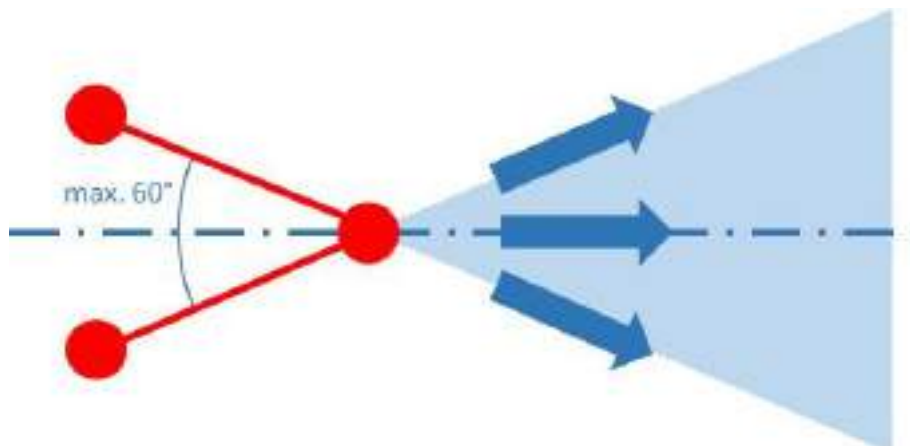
Dreieckverankerung mit drei Stäben (Grundriss).
